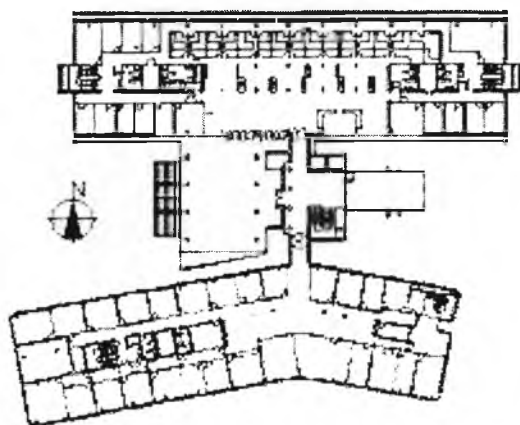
George du Toit Administrasiegebou – Plan Grondvloer
